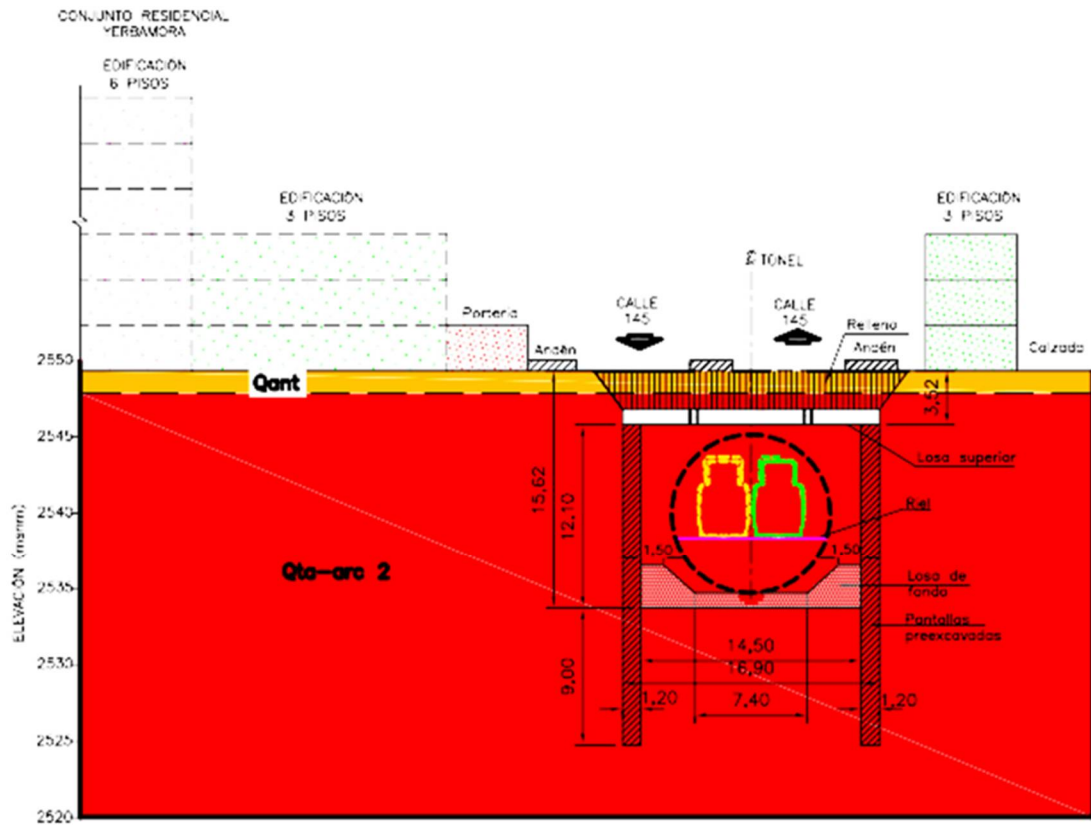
Sección transversal del pozo de entrada (a la izquierda, costado norte)
